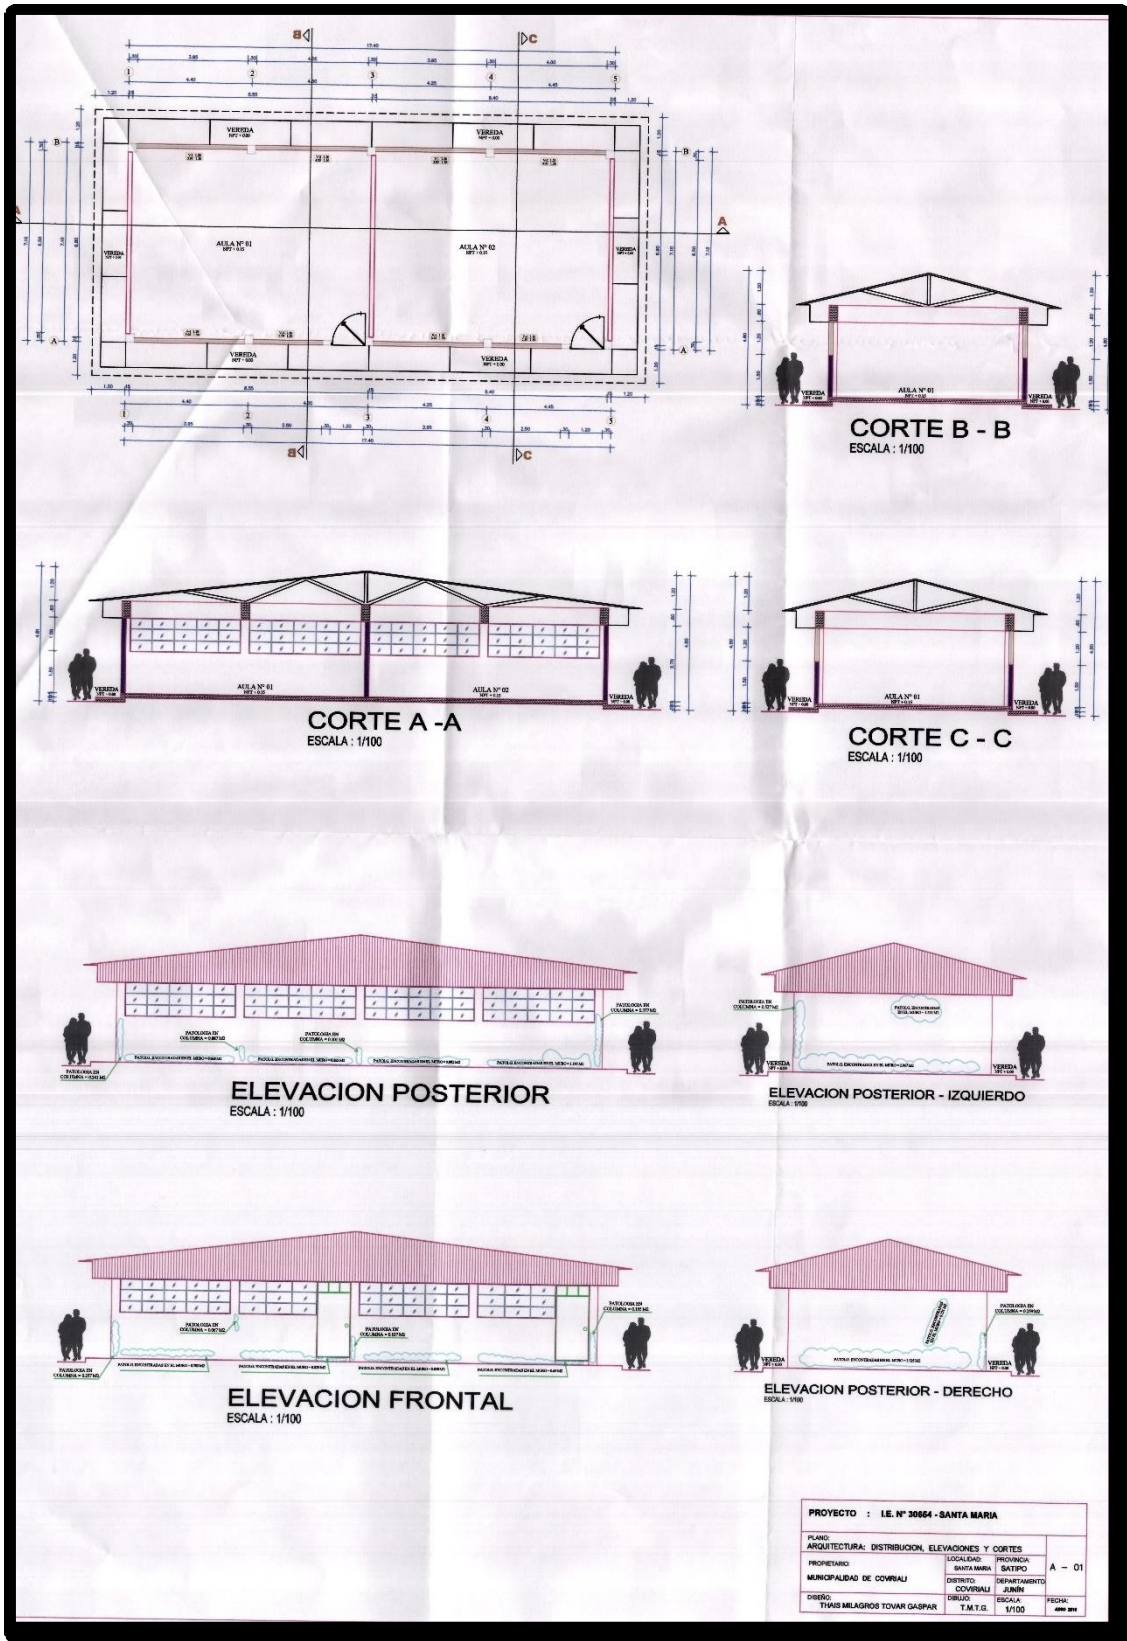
Plano de distribución, elevación y cortes de la institución educativa N° 30654 – Santa María
